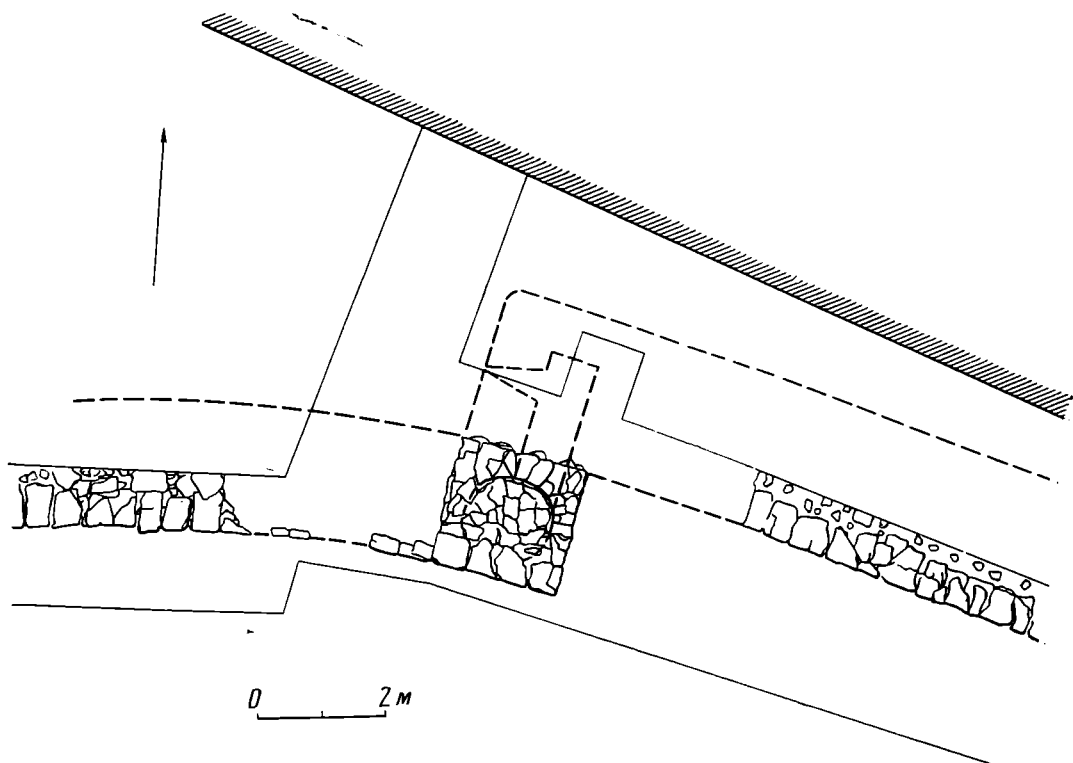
Уступ стены 1297 г. План с обозначением лестницы и бойницы
